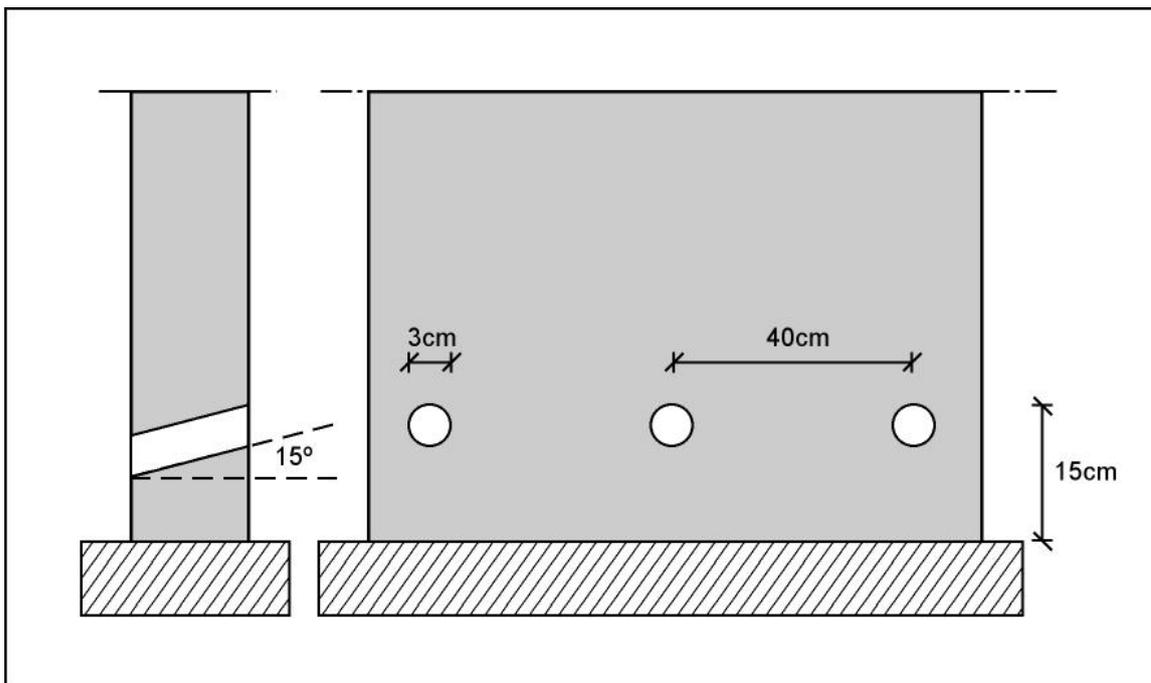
Vista frontal y lateral de un muro tratado con sifones knapen.
